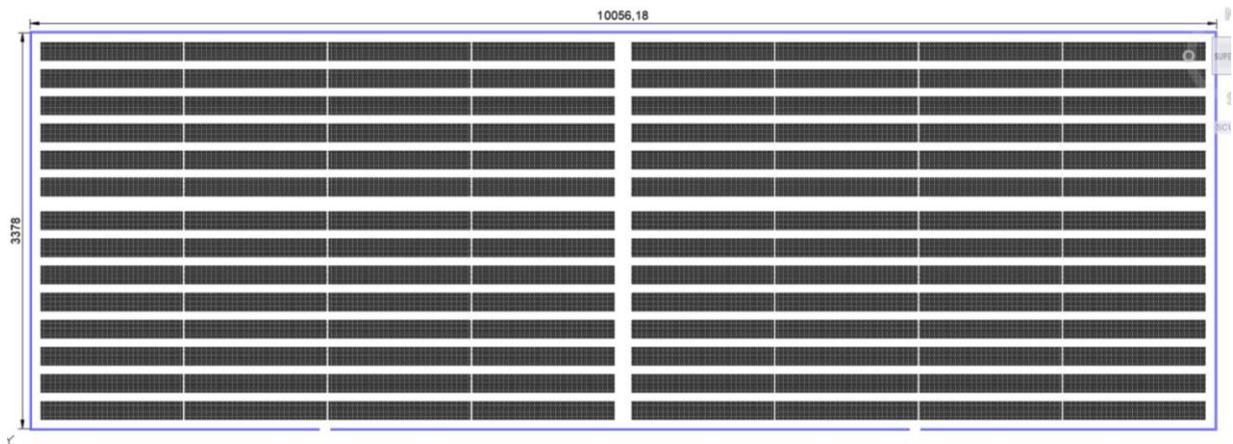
Plano zona maduración. Fuente: Elaboración propia
